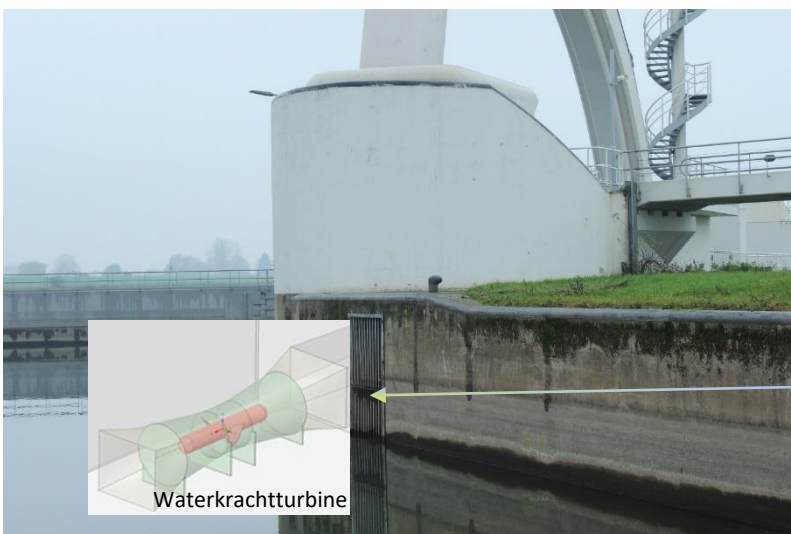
impressie waterkrachtturbine bij de inlaat van de vissluis (noordpijler)
